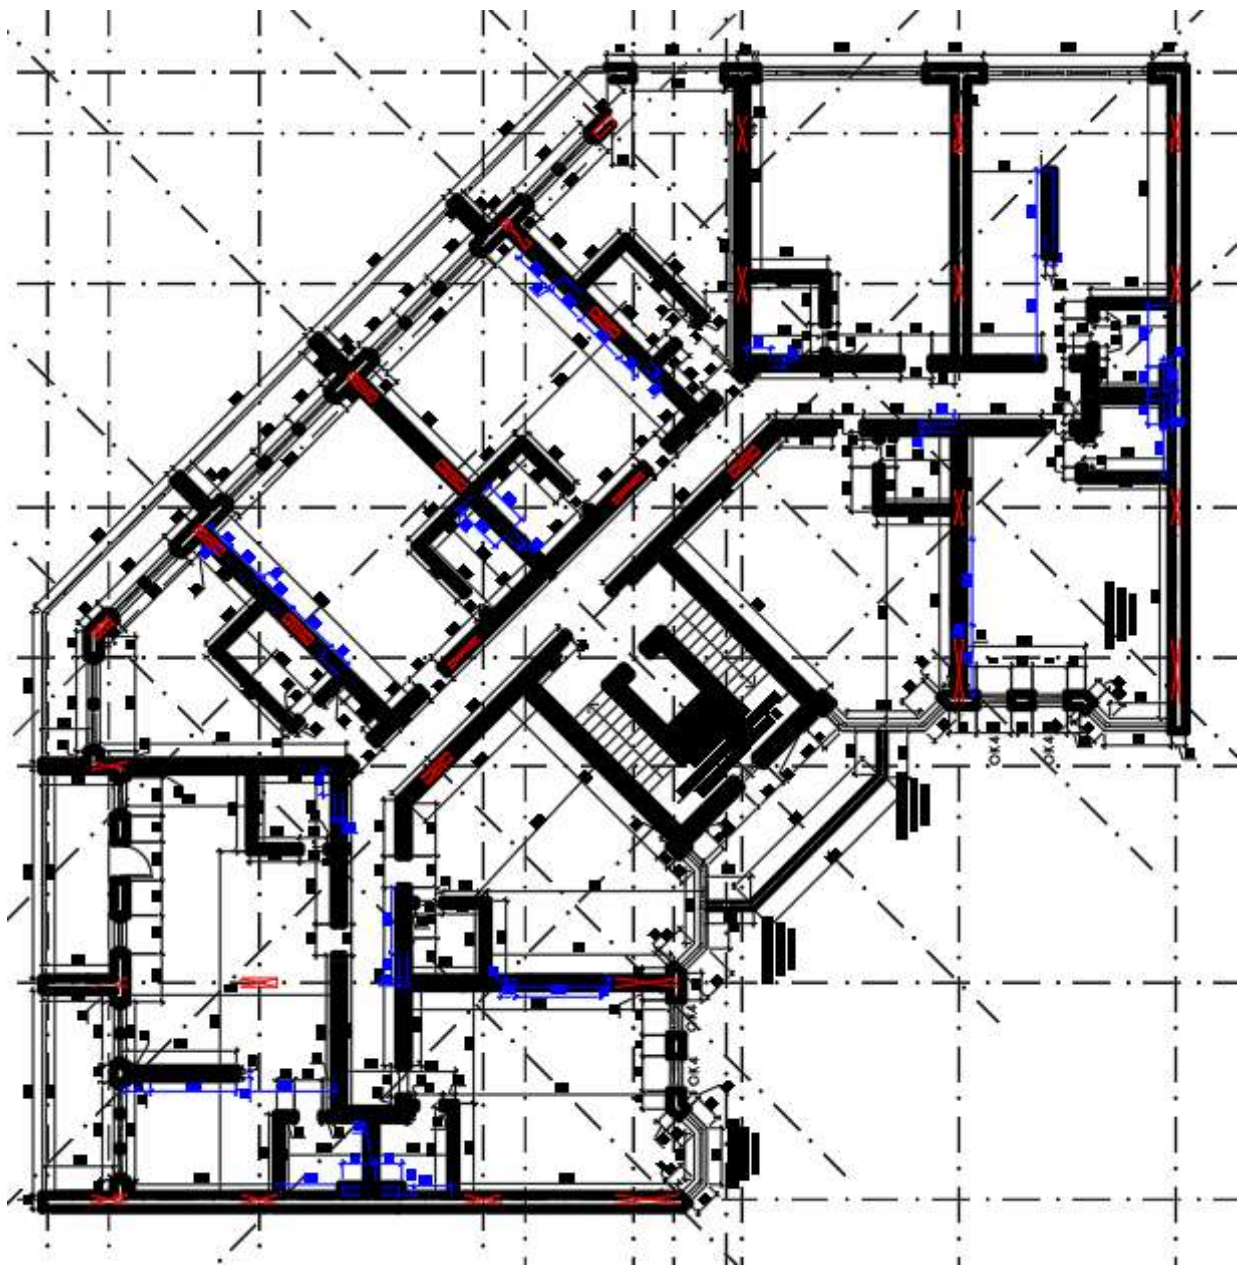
План розташування залізобетонних елементів та огорожувальних конструкцій кутової секції житлового комплексу «Авіньйон»
